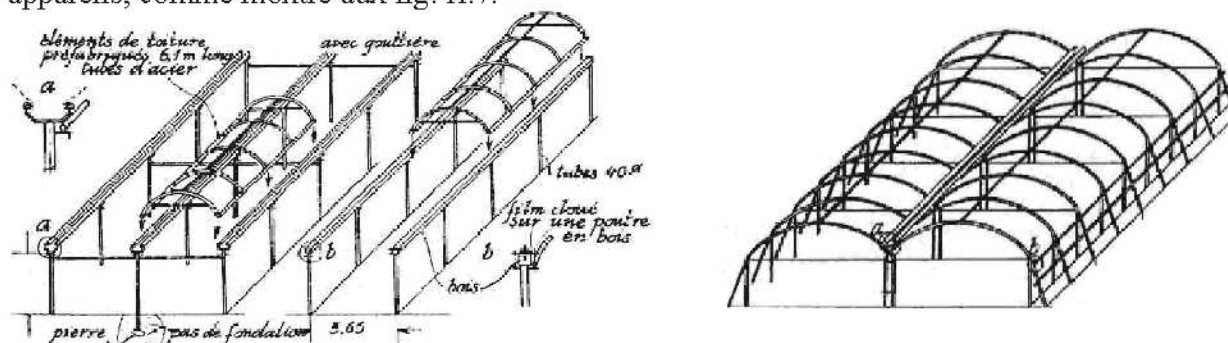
Constriction métallique. A gauche : avec éléments de toiture préfabriqués.
